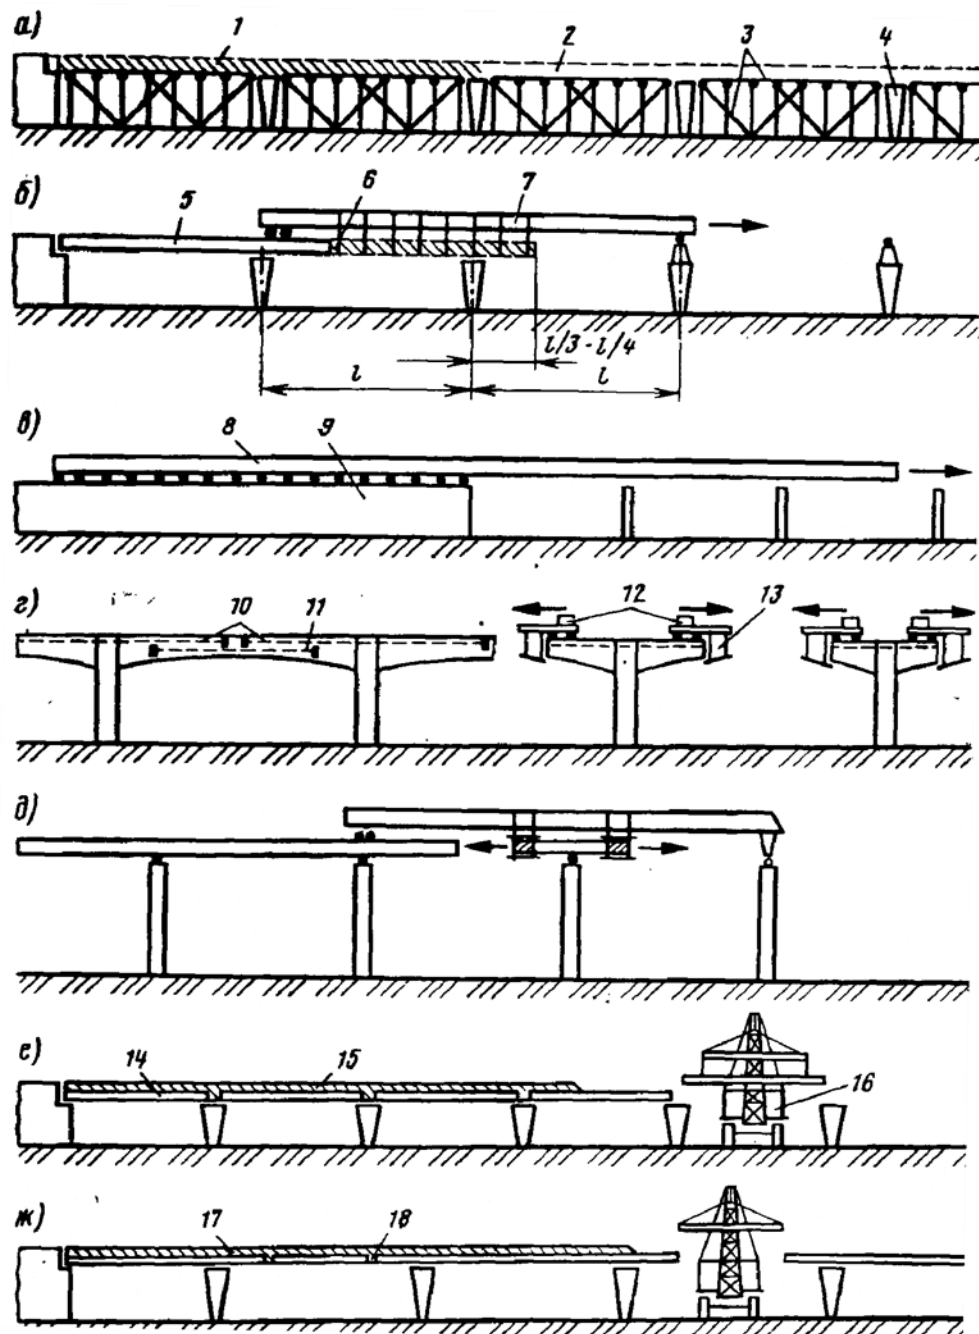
Схеми зведення прогонових будов естакад з монолітного та збірно-монолітного залізобетону: 1 – бетонована монолітна конструкція; 2 – опалубка;
